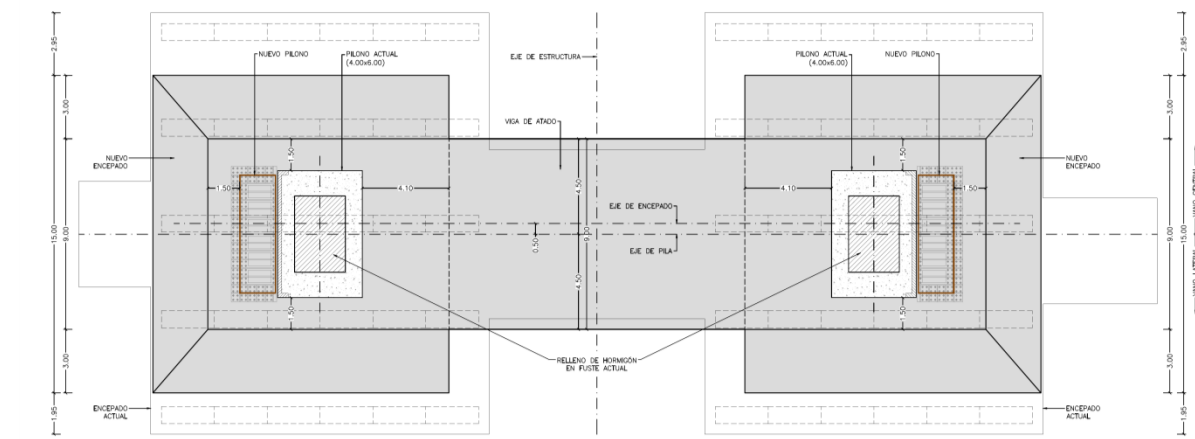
Vista en planta de la nueva zapata sobre el encepado actual.
